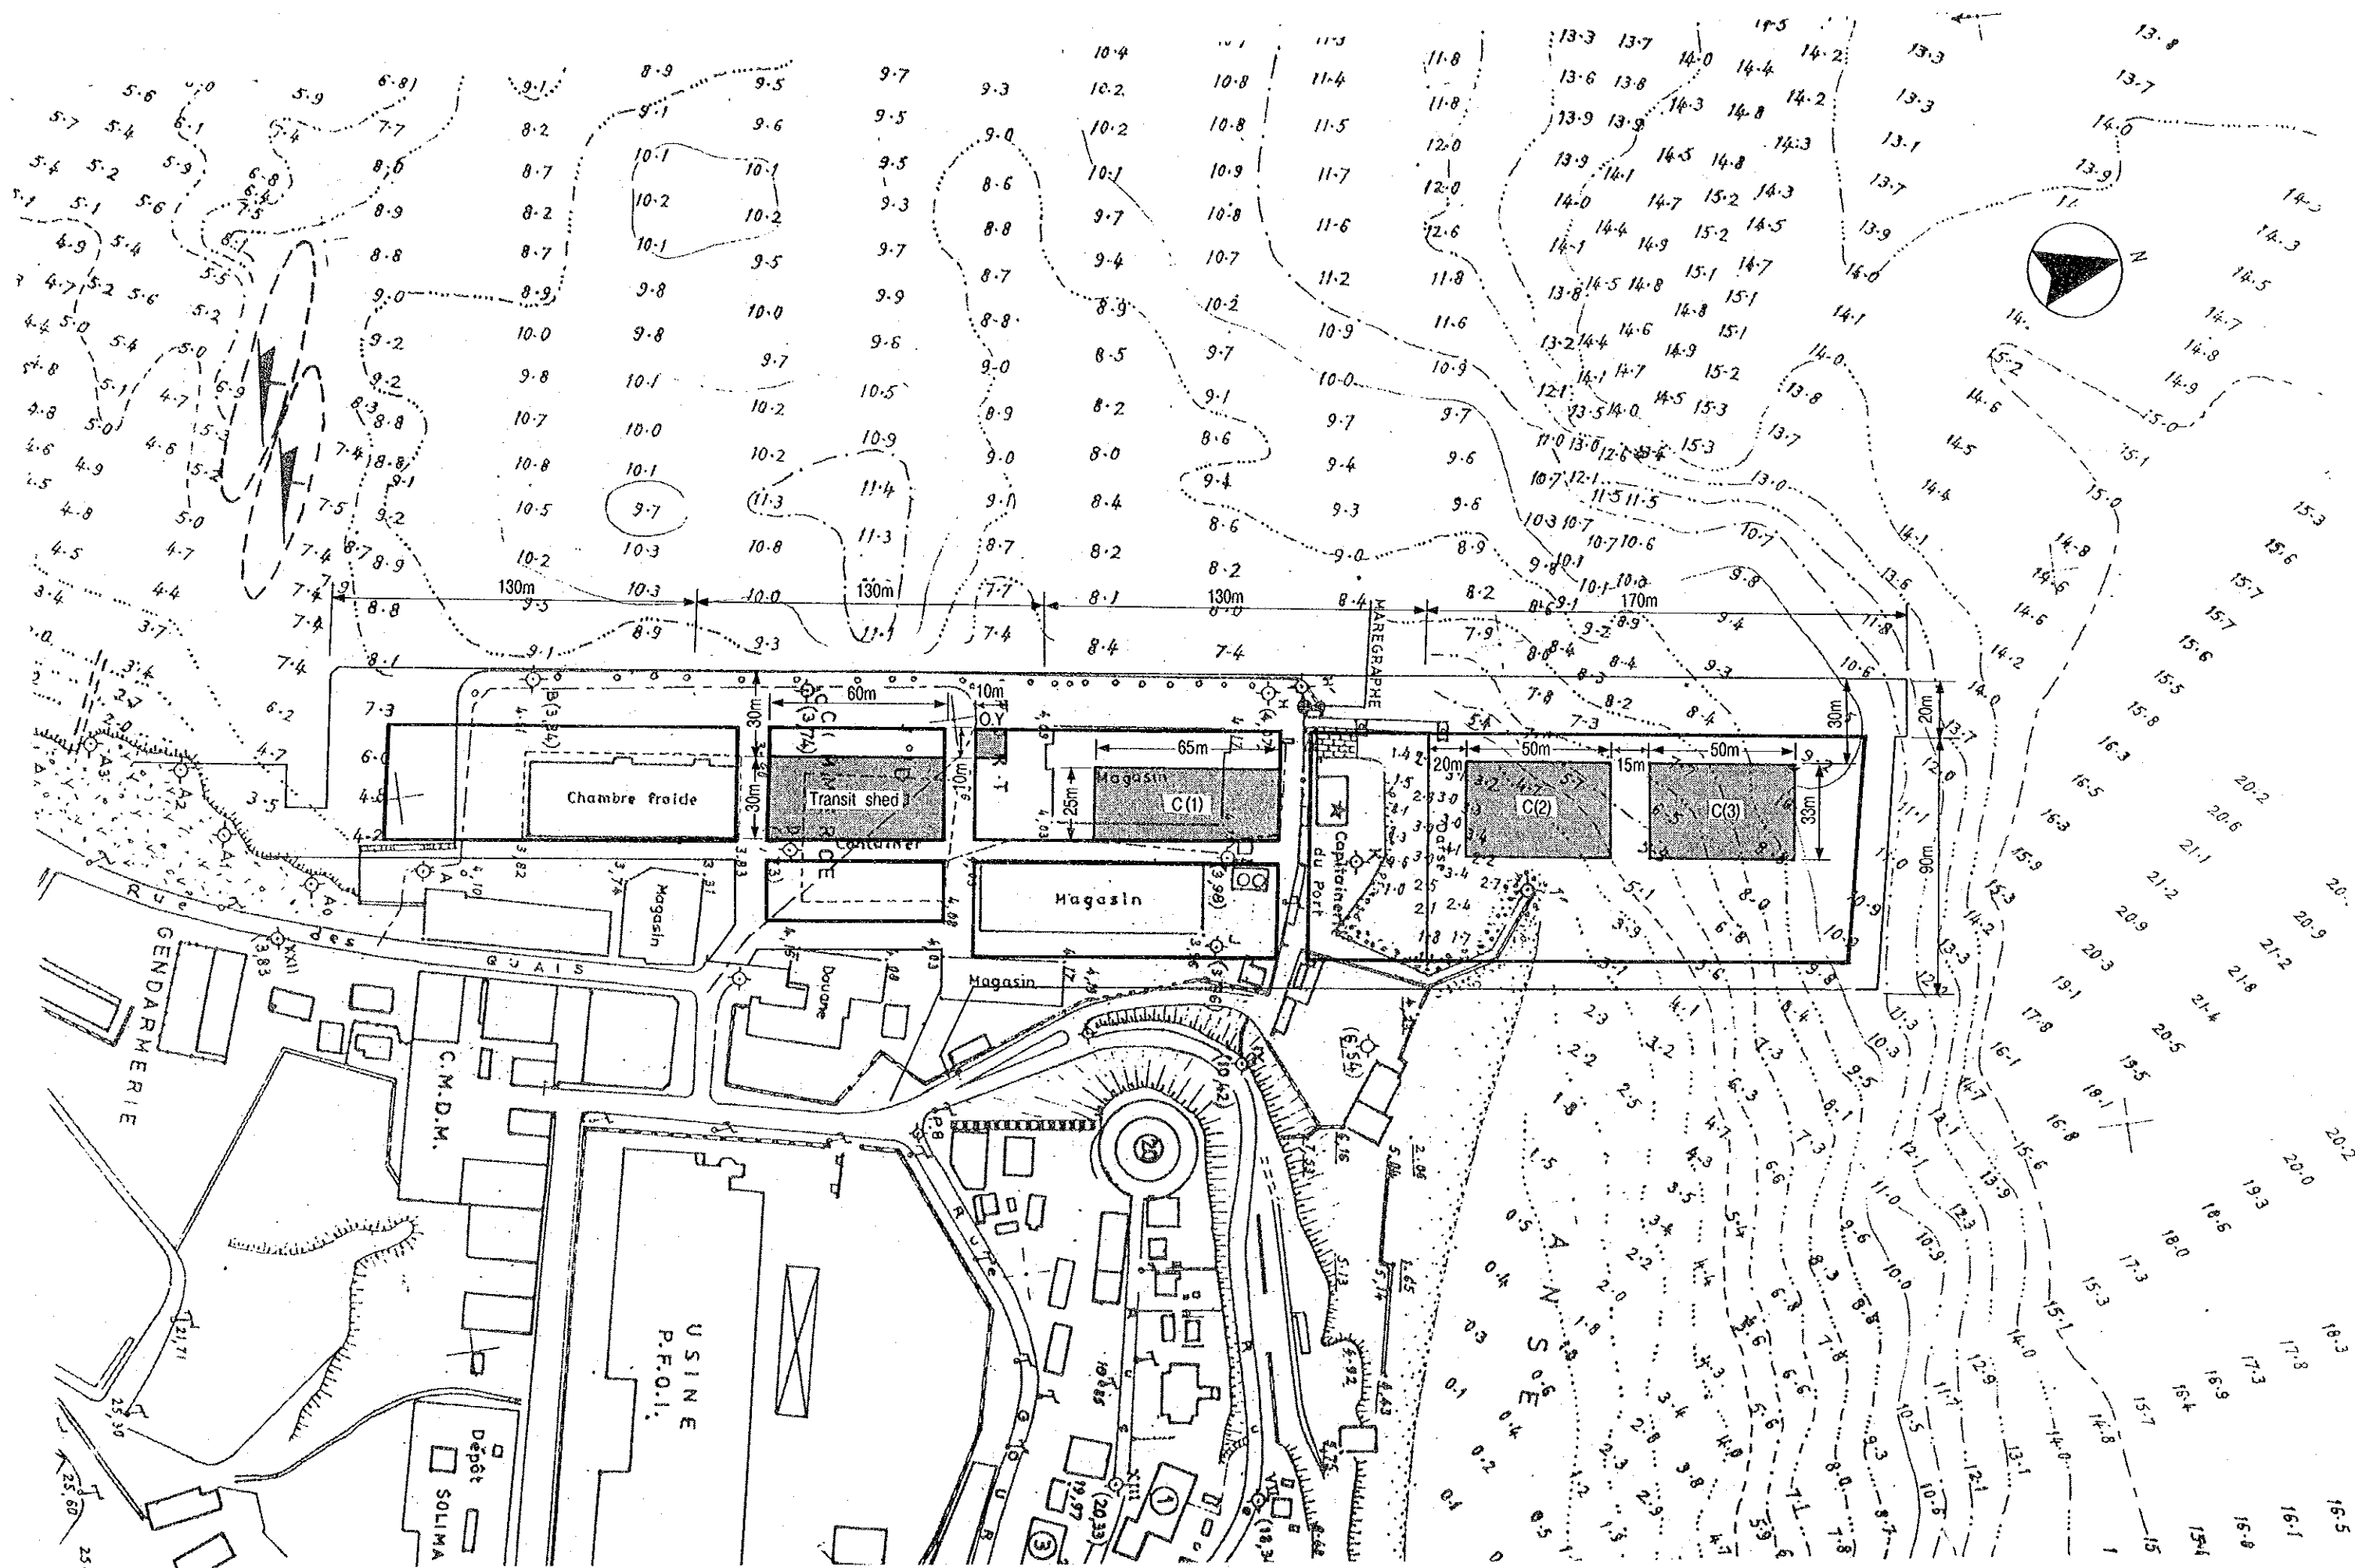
Tracé Alternatif du Plan de Développement à Court Terme
